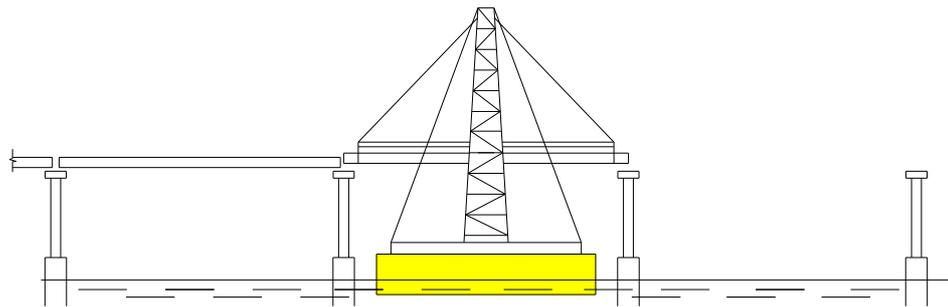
Варианты принципиальных схем монтажа разрезных балочных пролетных строений самоходными стреловыми кранами:
